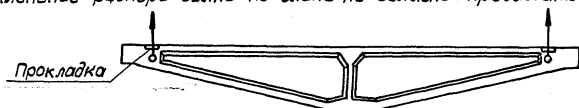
Схема строповки балки при подземе в вертикальном положении (при установке на колонны)
